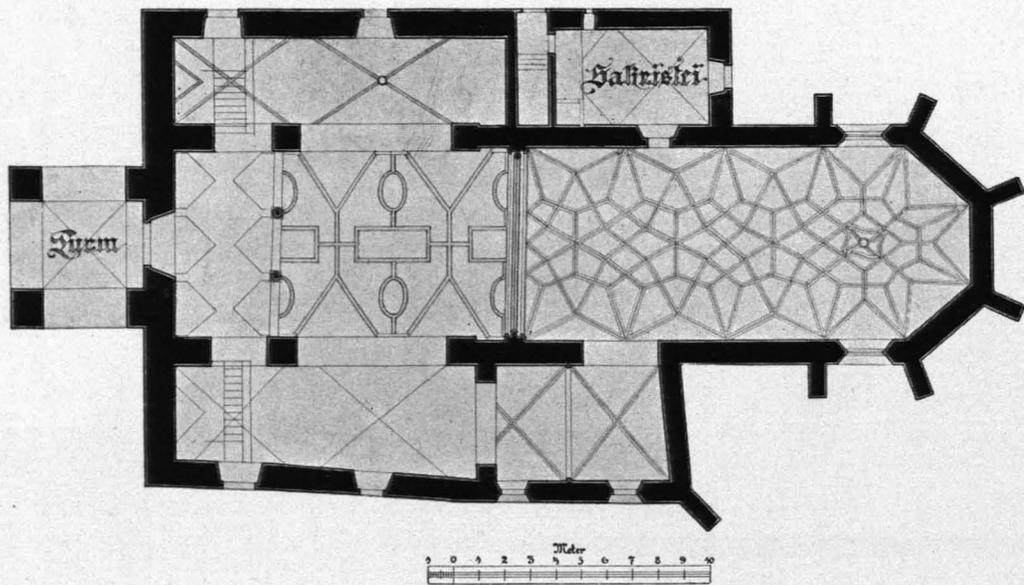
Ferschnitz, Pfarrkirche, Grundriß 1:300 (S. 43)
